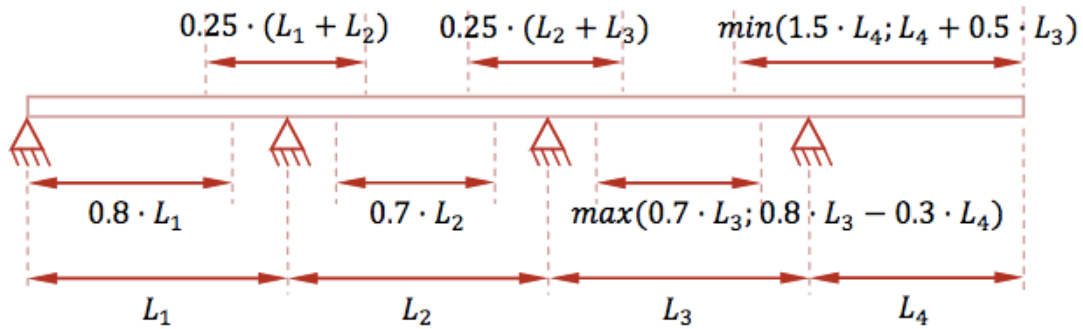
Cálculo del ancho efectivo para cada viga longitudinal.
